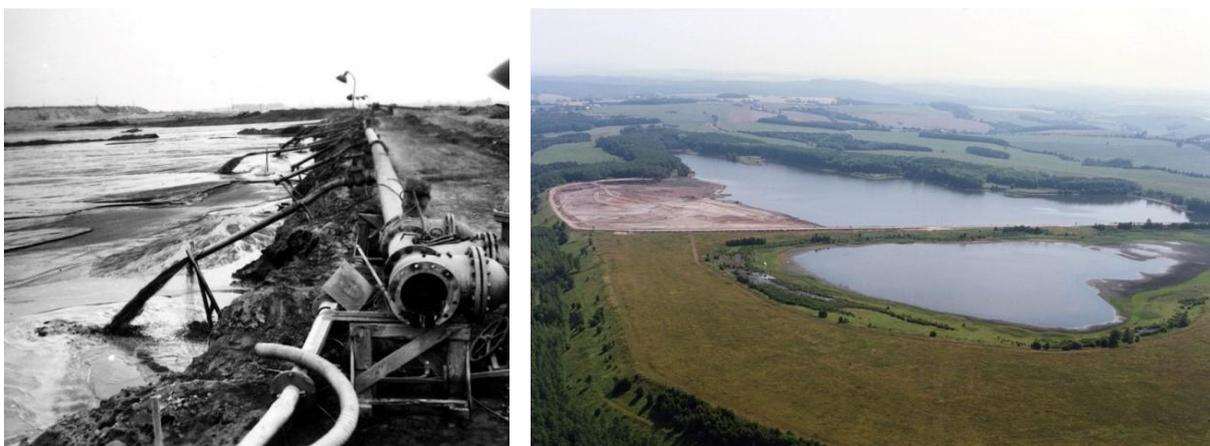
Remediación de planta de decantación industrial Trünzig.
